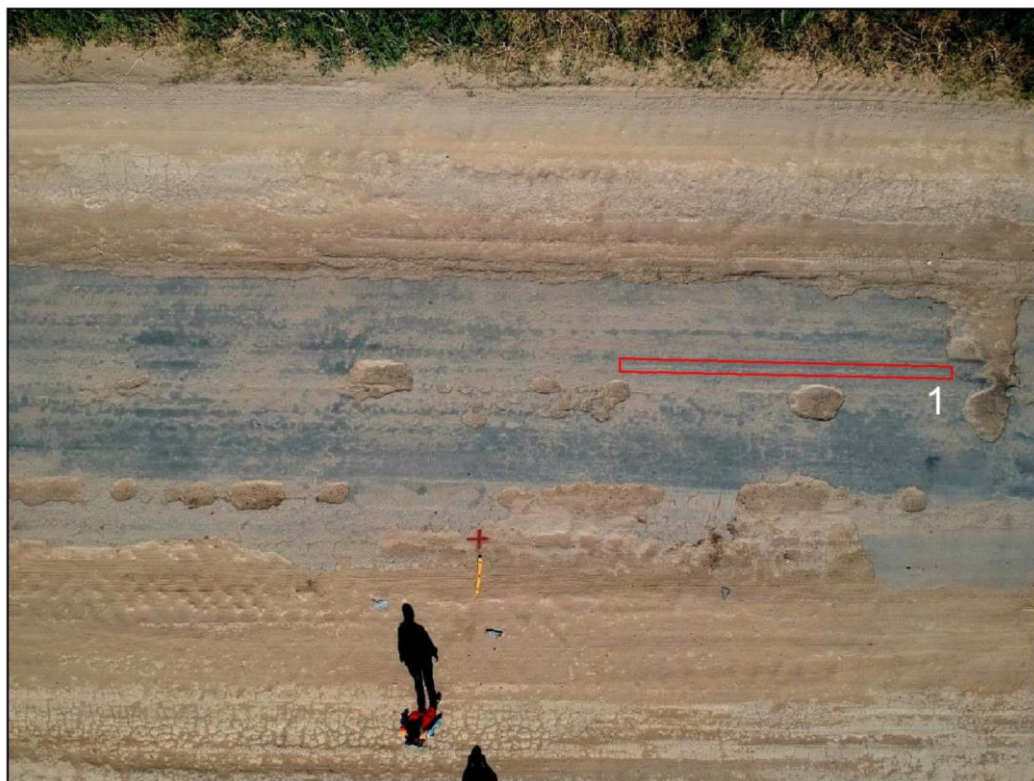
Fisura longitudinal. Tramo 1 - imagen 1204.
